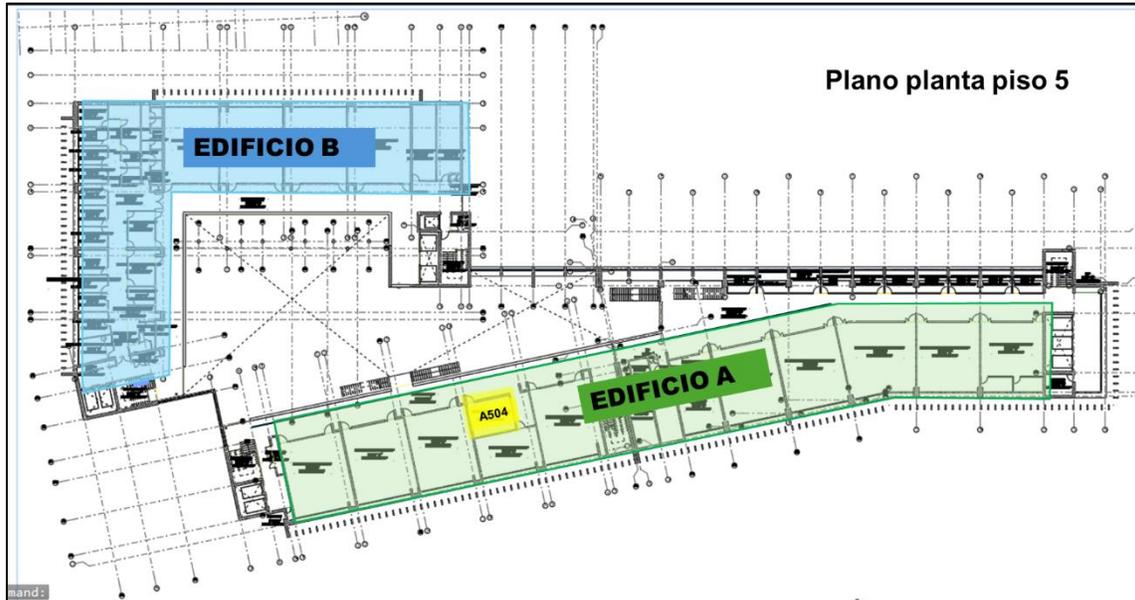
Plano general del piso 5 Sede Bellavista – AutoCAD
